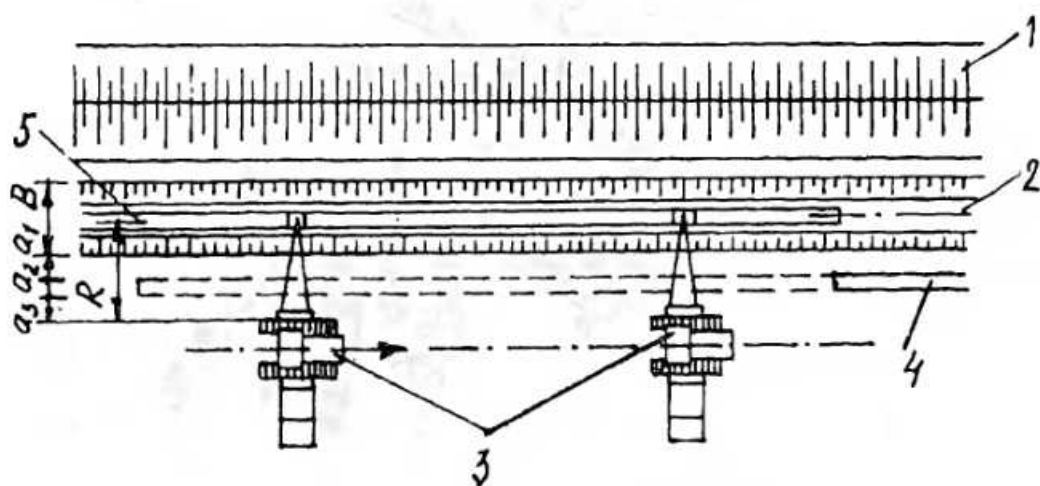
Схема вкладання трубної ланки в траншею: 1 - відвал ґрунту; 2 - траншея; 3 - тракторні крани; 4 - трубна ланка; 5 - проектне розташування трубопроводу
